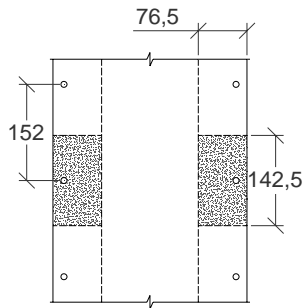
Sección longitudinal de la viga del ensayo de Abersman y Conte (1973). Detalle de las áreas efectivas de la armadura pasiva transversal, según el criterio definido en el MC CEB-FIP 1990.
